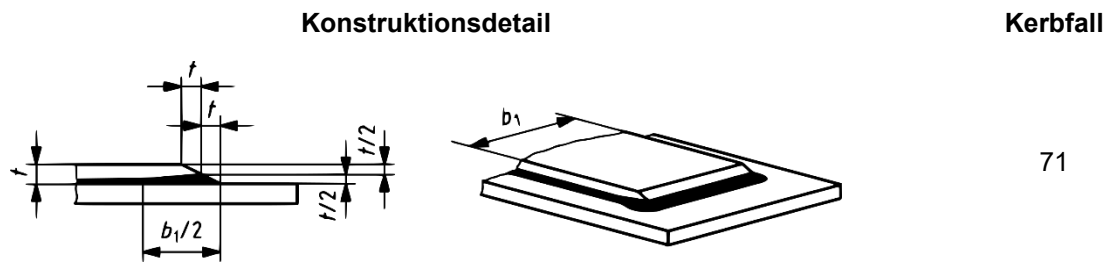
Gurtlamelle mit verstärkter Stirnnaht auf Walz- und geschweißten Trägern mit Kerbfalleinstufung nach DIN EN 1993-2/NA [94]
